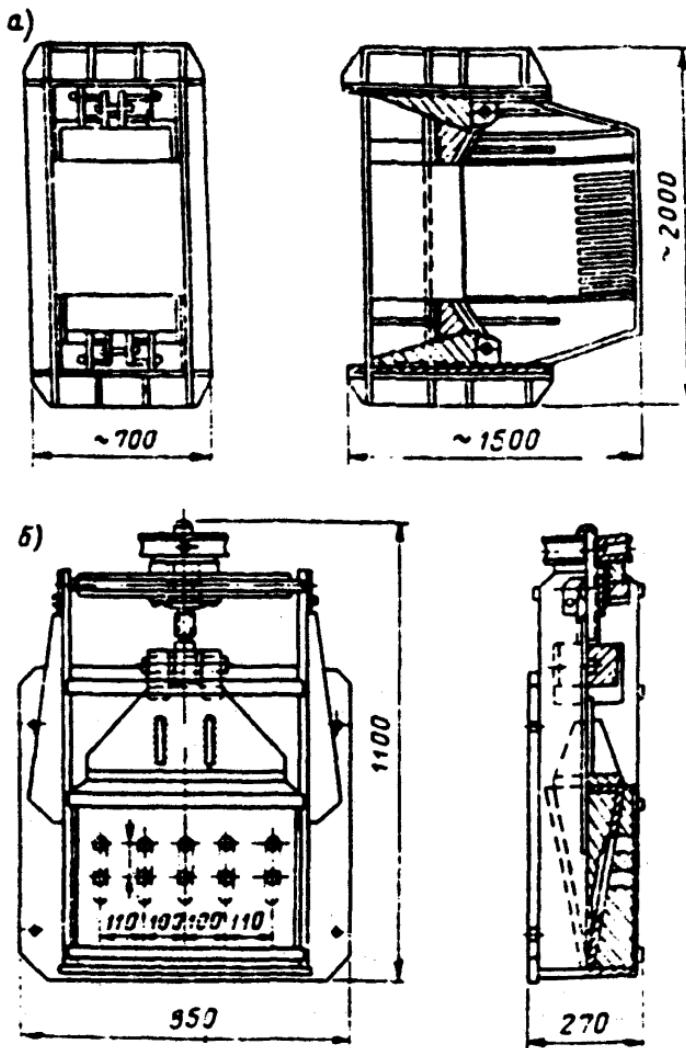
Клиновое устройство для отпуска натяжения арматуры, натягиваемой на упоры стенда
